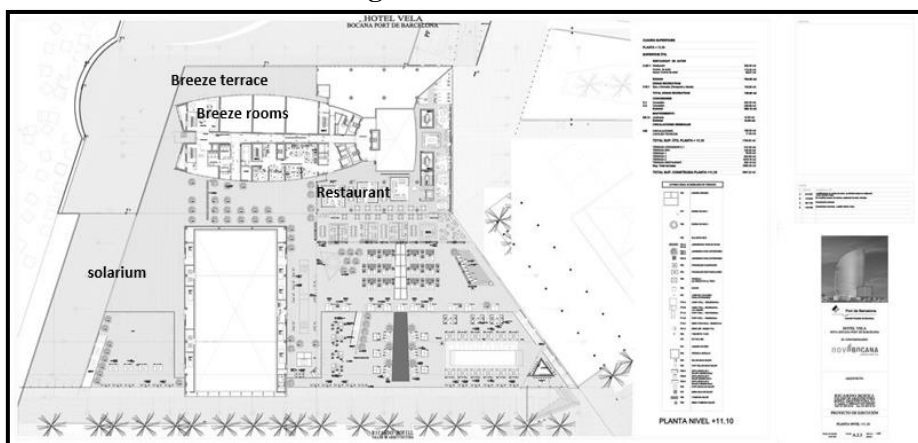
Plan du 1<sup>er</sup> étage Hôtel W
